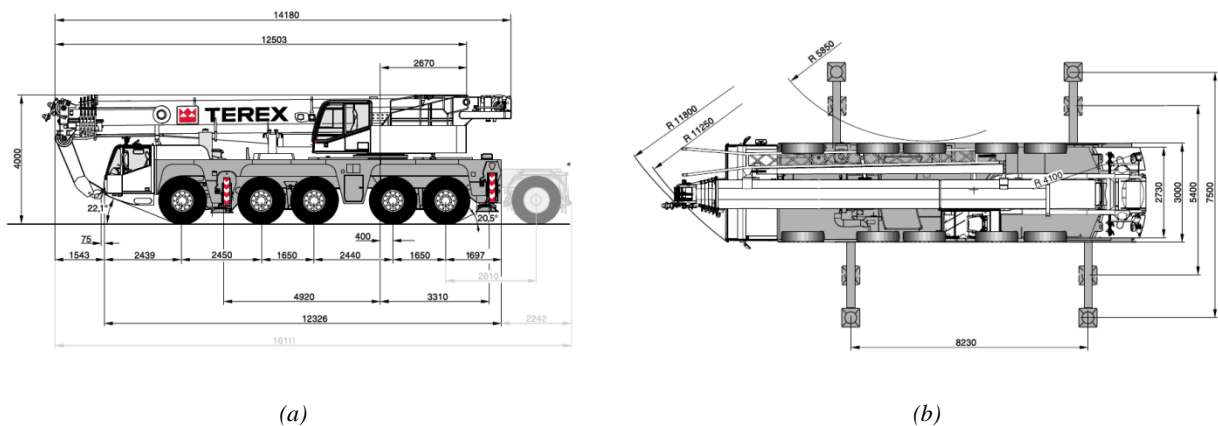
Grúa Terex AC 140 – (a) Vista lateral; (b) Planta (Intertechne, 2014)
